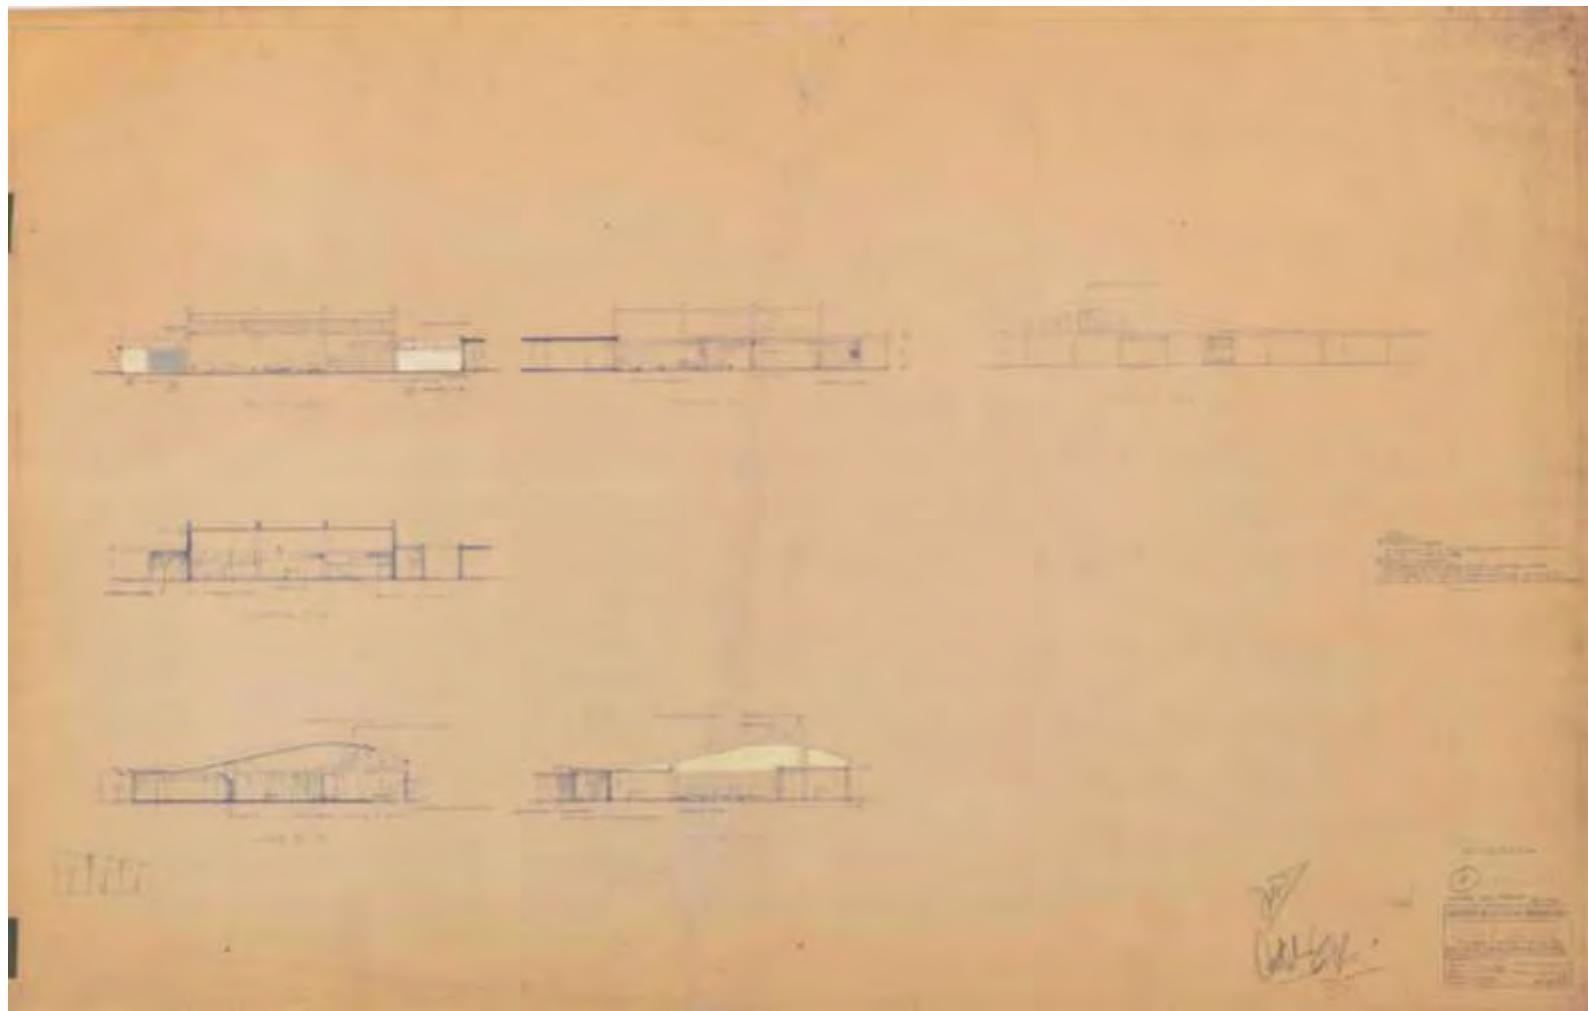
Plano 36-A-6-4. Sección A Biblioteca Fachada Cortes y Detalles. (Colores V. Valera). Fuente: Colección CUC-ICU / COPRED-UCV.
